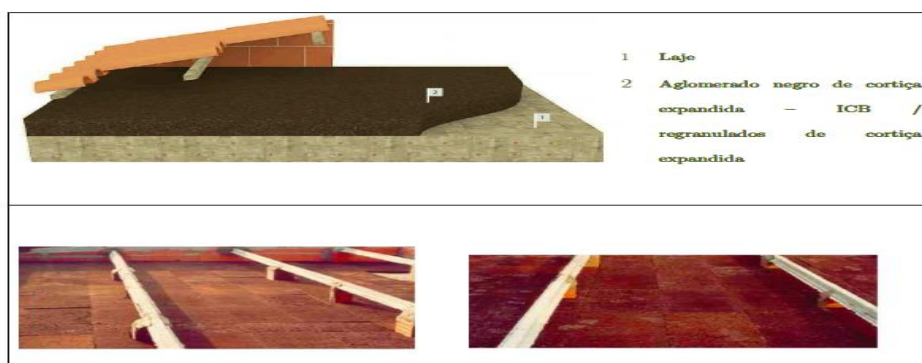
Exemplo de isolamento térmico e acústico utilizando cortiça em lajes de esteira
